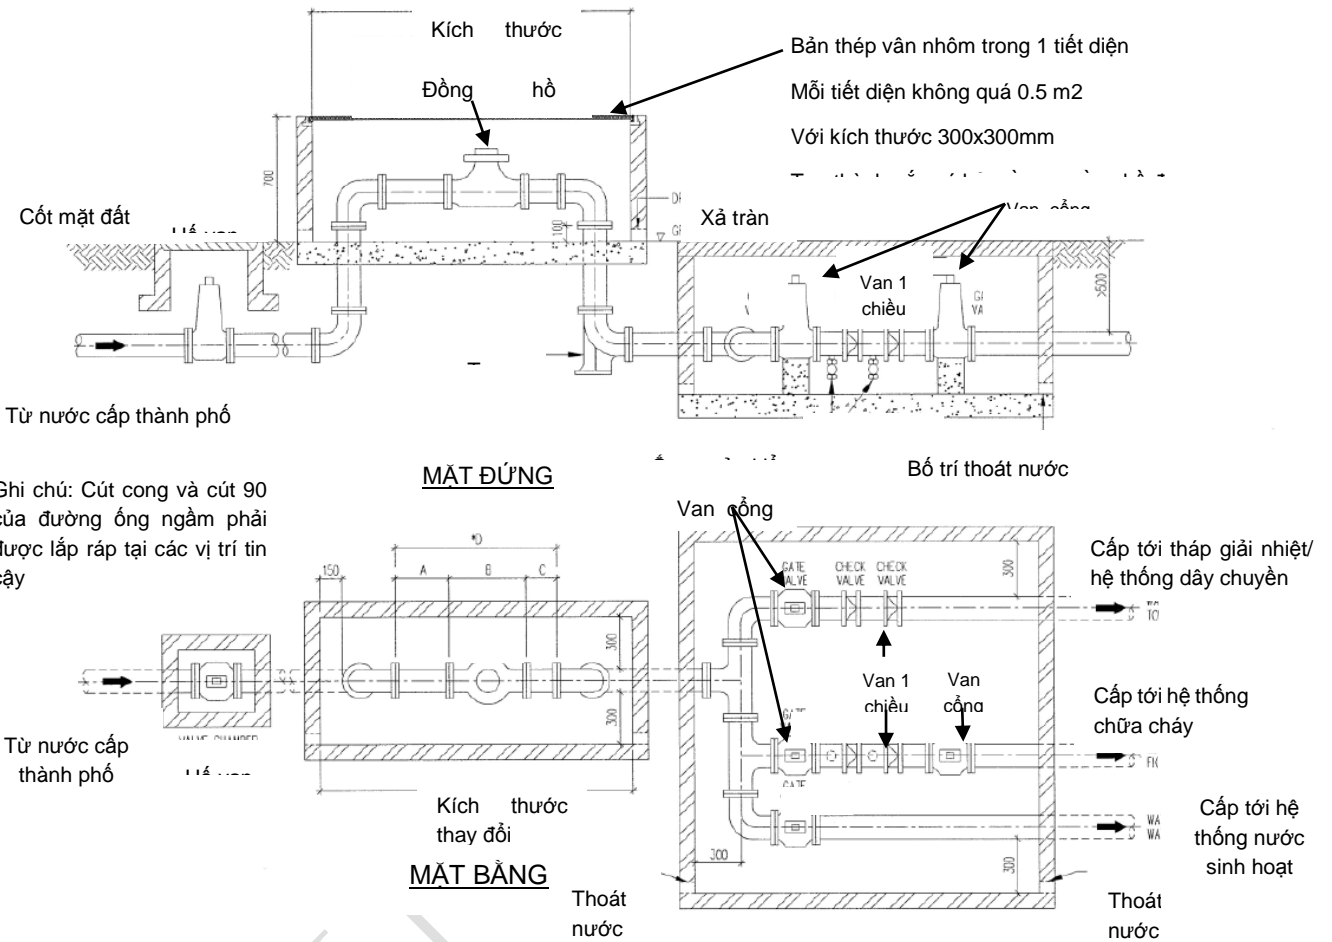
Đồng hồ D15 mm bố trí trên mặt đất.
